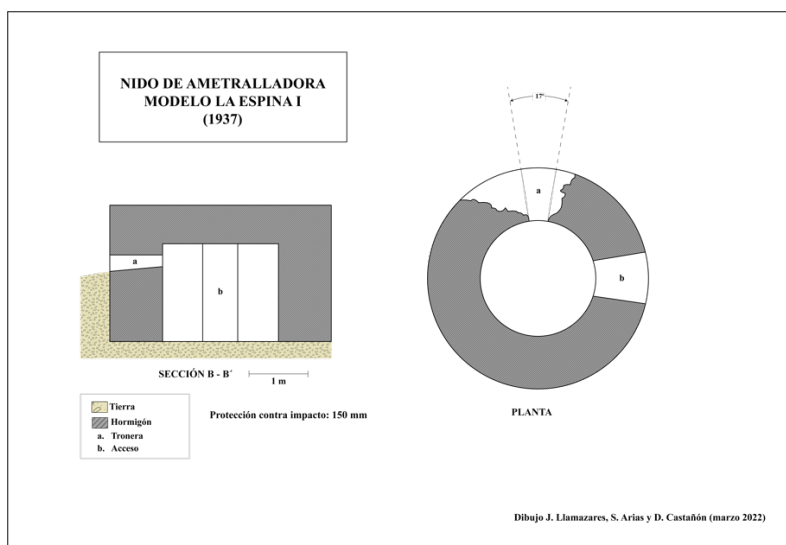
Plano en planta y sección del nido de ametralladora de La Espina I (Villanín, León). Autor: Javier Llamazares, Sergio Arias y Daniel Castañón.
